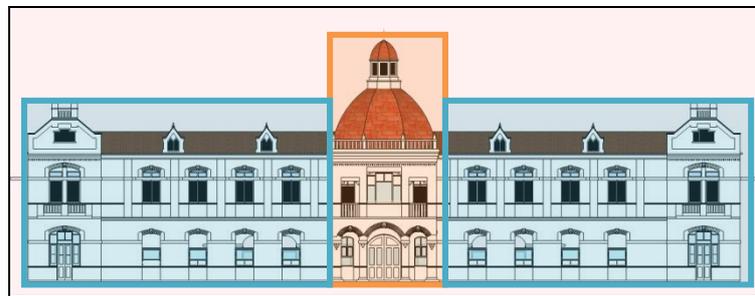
Denah 'Halo Surabaya' dengan bentuk simetris
